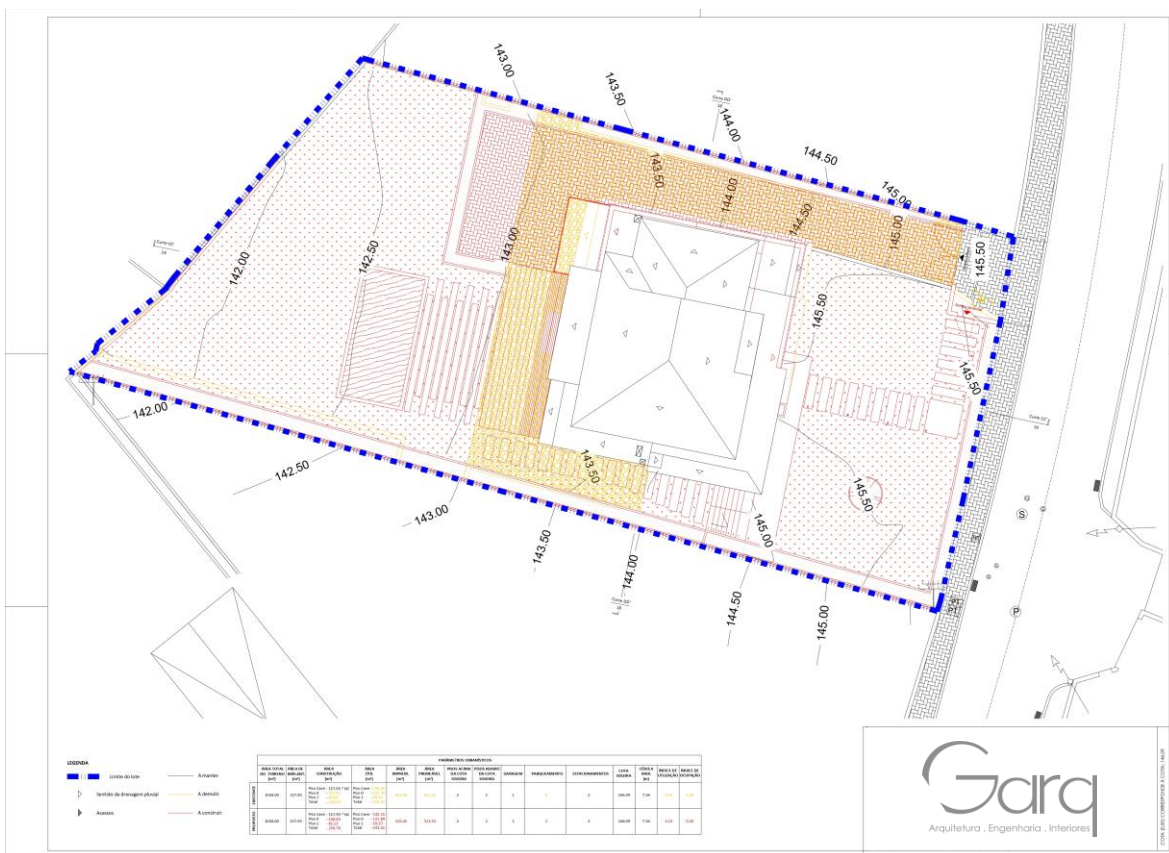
Vermelhos/Amarelos - Planta de implantação sob. lev. topográfico (LIC_R00). Fonte: Garq / Desenvolvimento: Autora.
